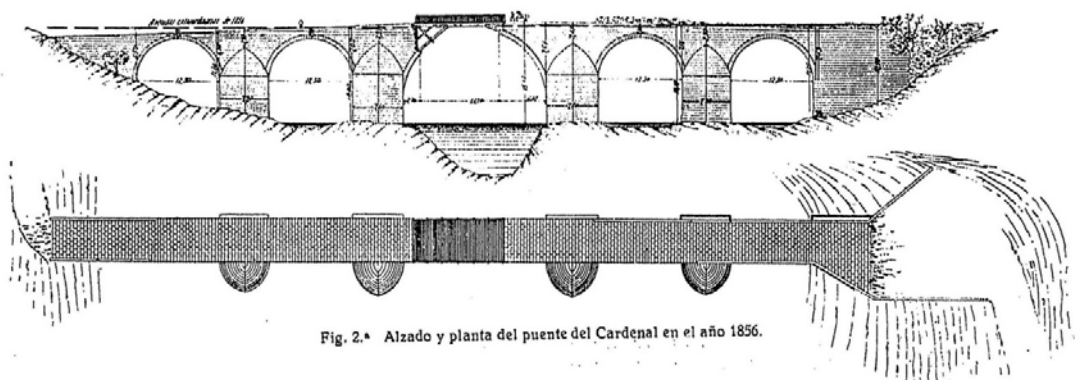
Estado del puente en 1856. Fuente: MACHIMBARRENA, V. (1926)
